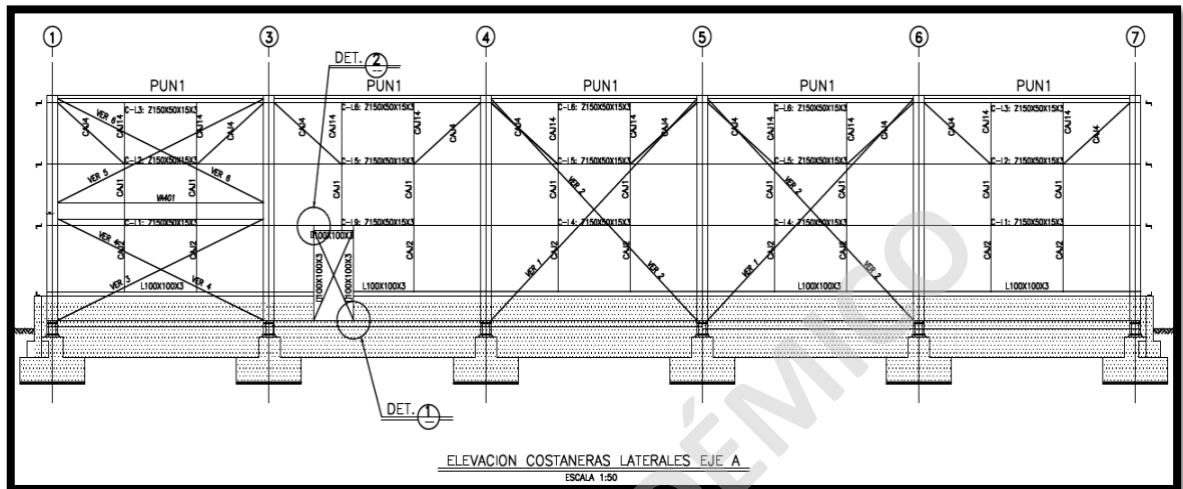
Elevación de Eje A Colgadores ODR Ingeniería y Montaje.
